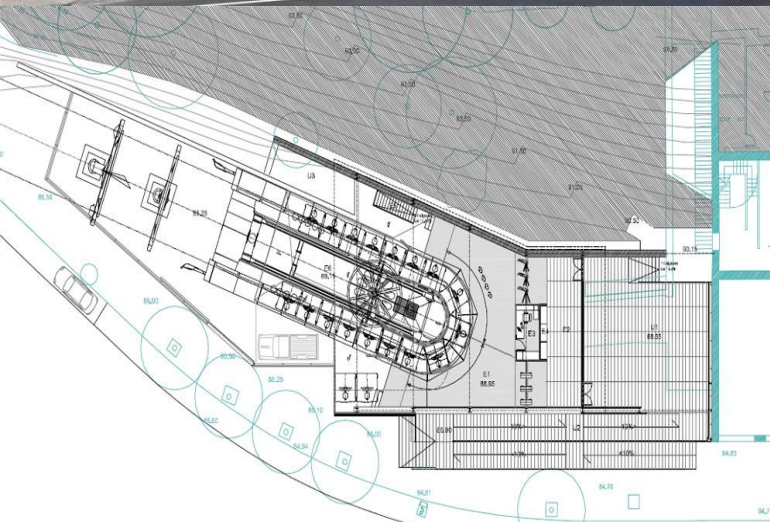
Planta estación de teleférico Montjuic. Jordi tost
